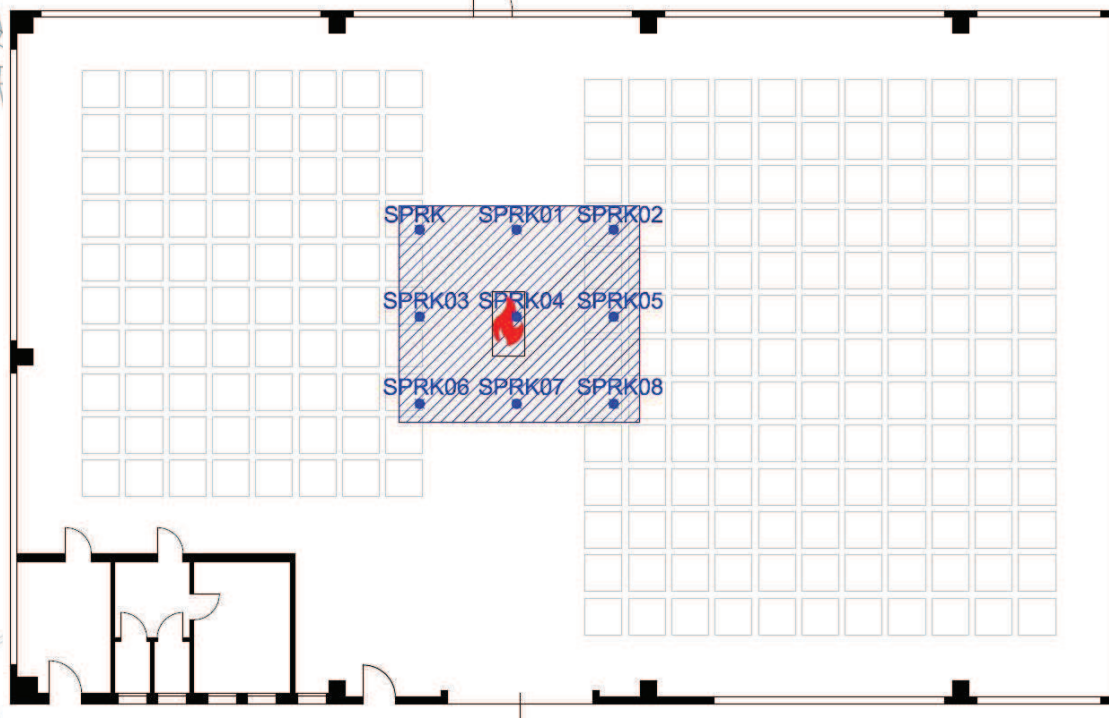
Collocazione in pianta delle testine sprinkler per lo scenario d'incendio collocato nell'area di movimentazione dei carrelli elevatori.
